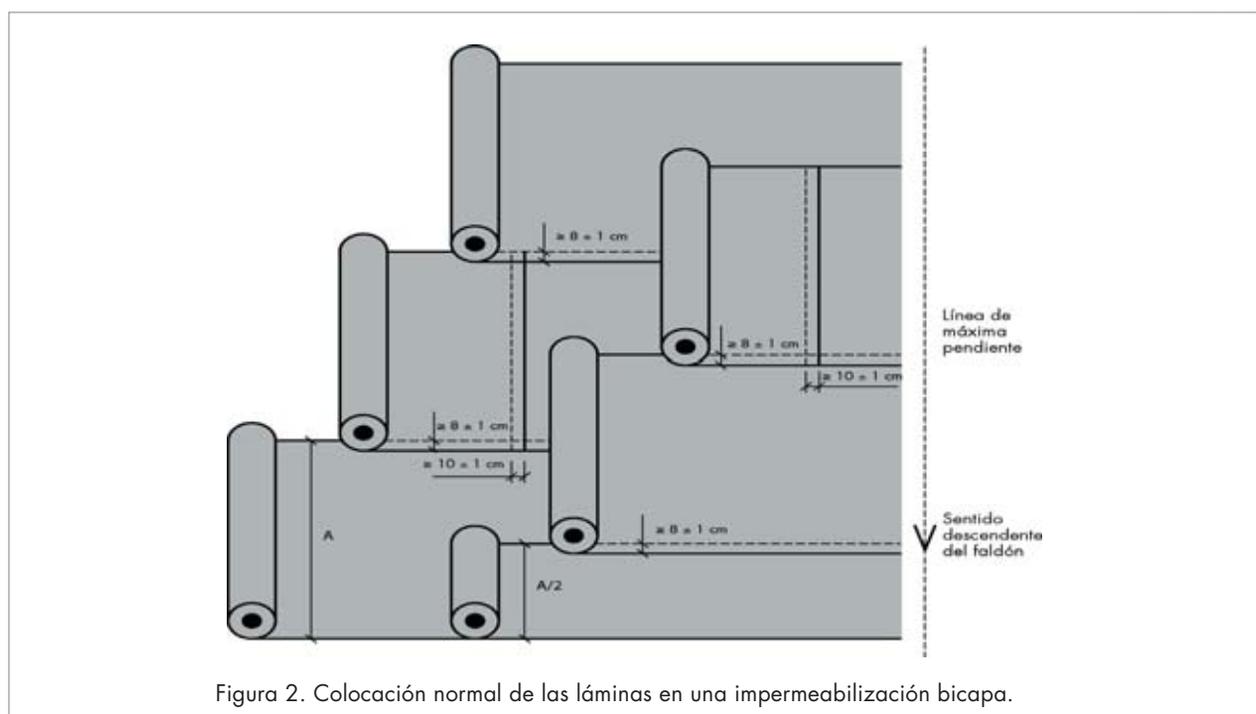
Colocación normal de las láminas en una impermeabilización bicapa.
